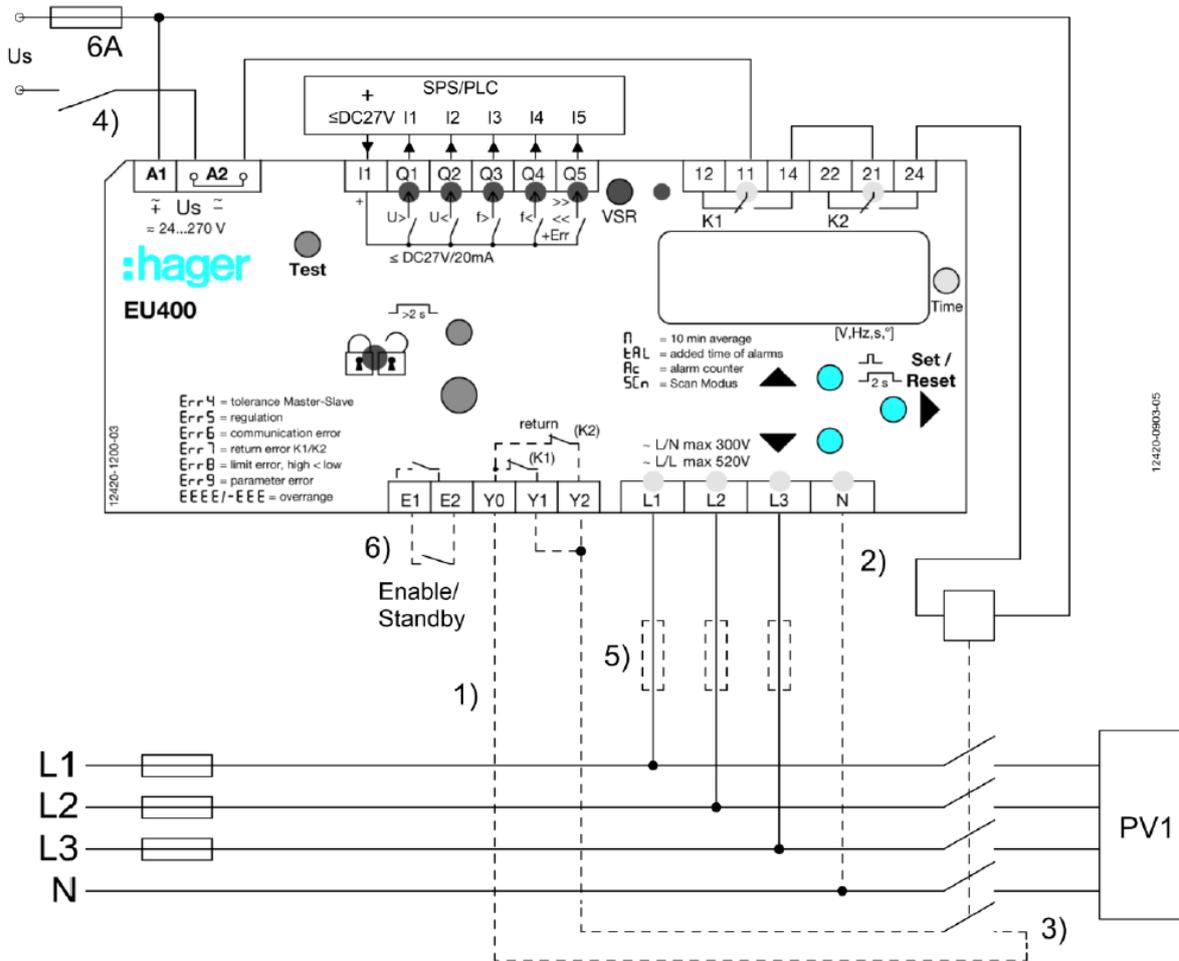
Schematischer Aufbau einer typischen Installation
